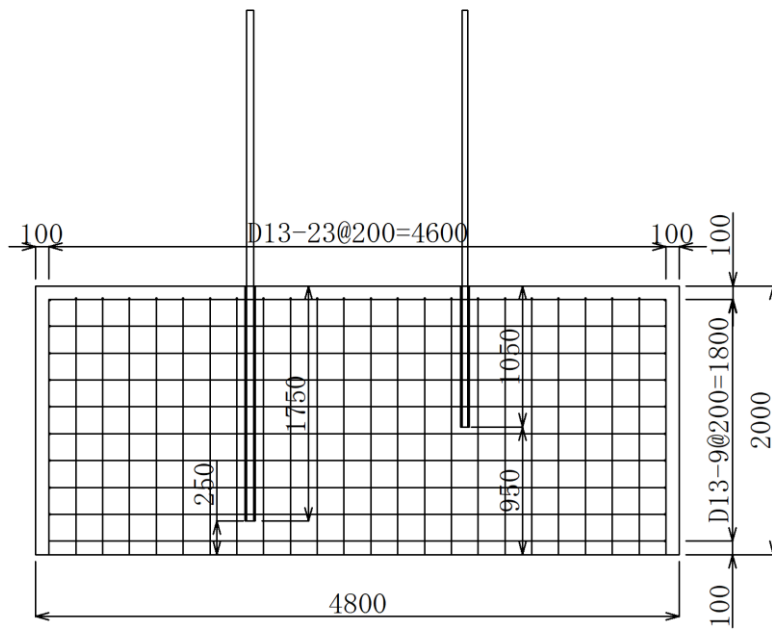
(3) 実験体①の配筋図 (B-B 断面図)
